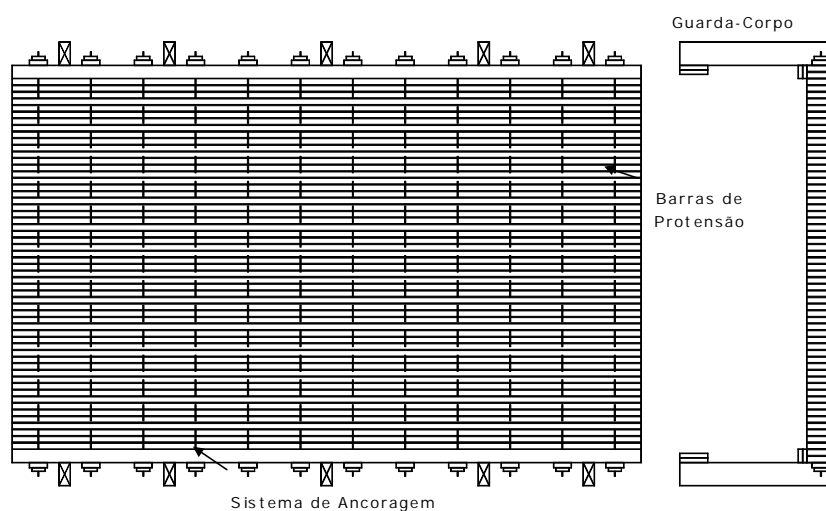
Planta e seção transversal de tabuleiro laminado protendido
